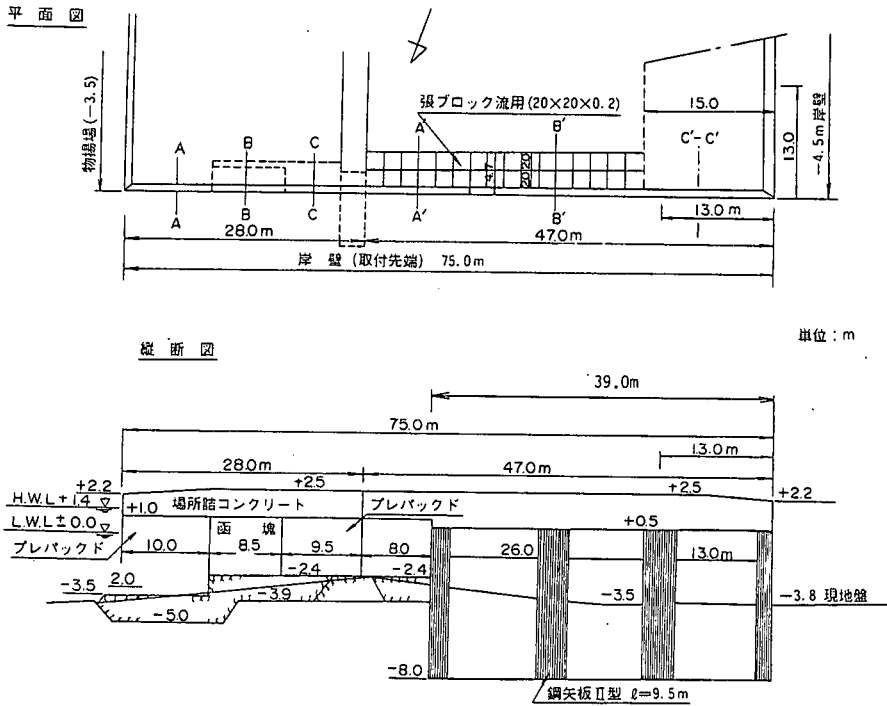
森港中央埠頭岸壁取付先端部平面図・縦断面図
